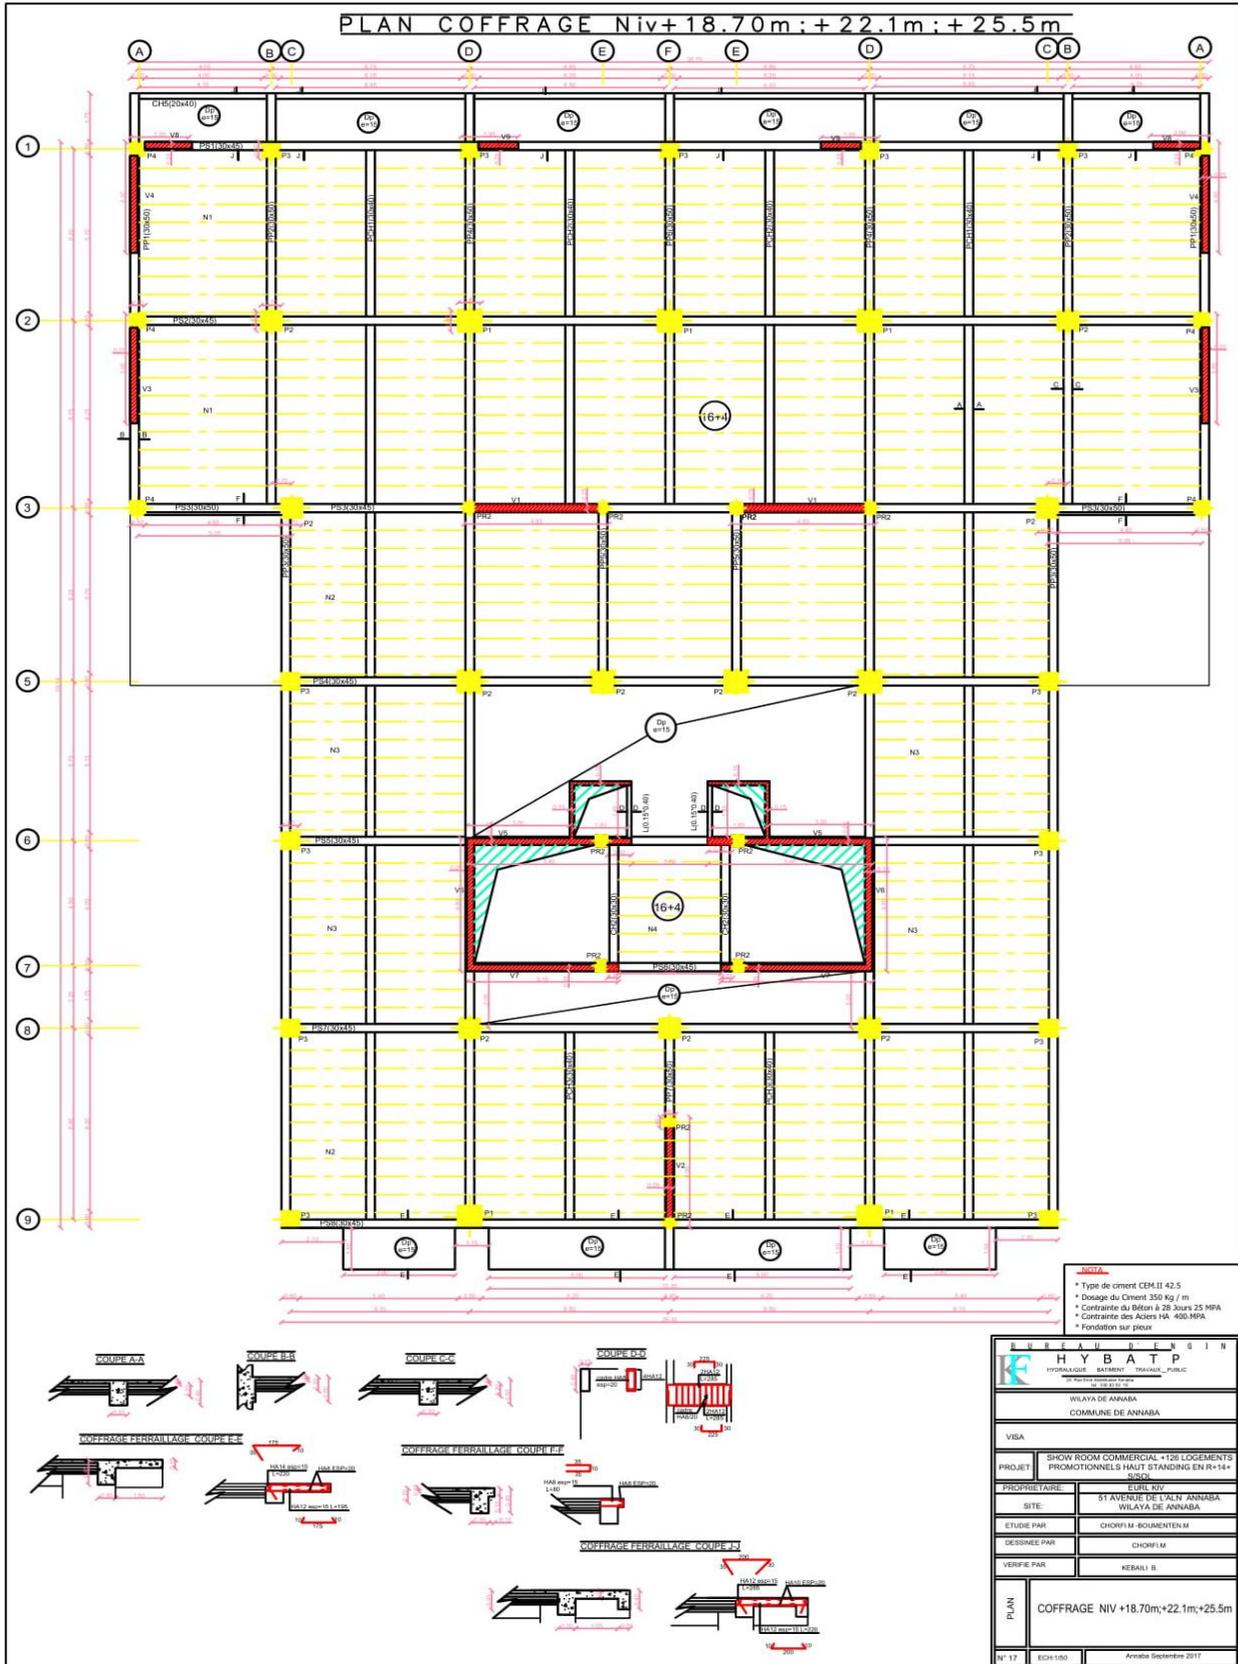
plan de coffrage NV +18.7m, +22.1m, +25.5m
